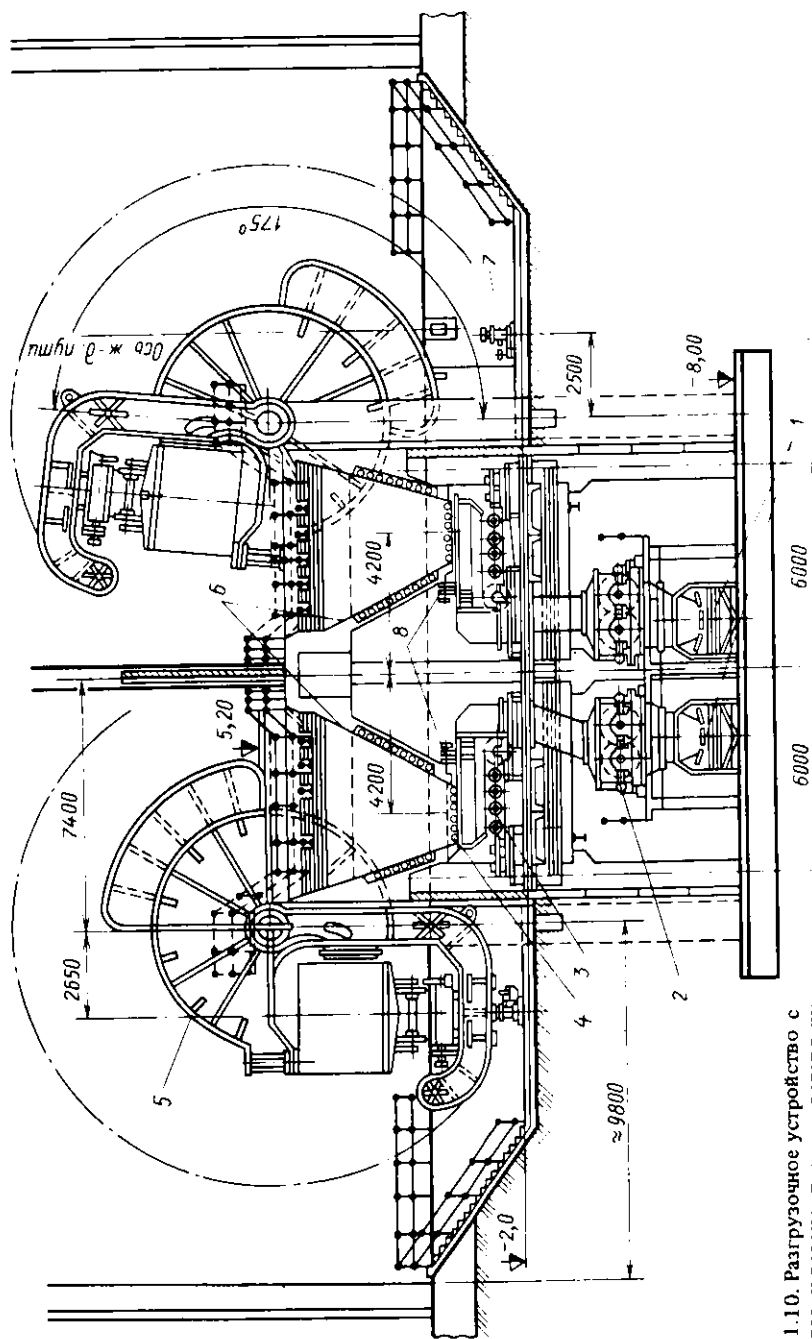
Разгрузочное устройство с боковыми вагонопрокидывателями:
